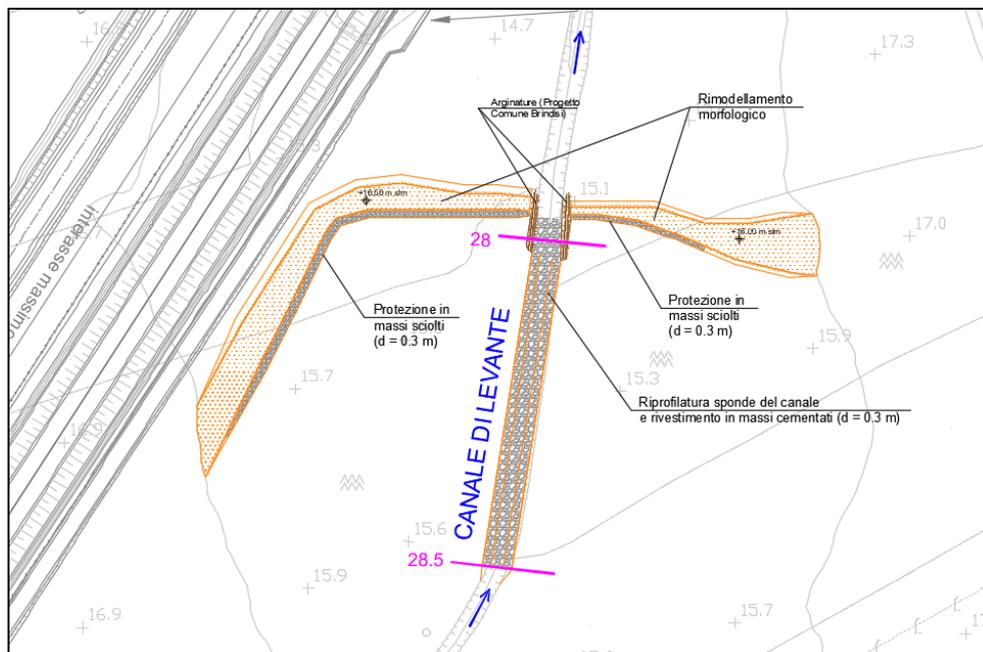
Canale di Levante: opere di sistemazione idraulica.
